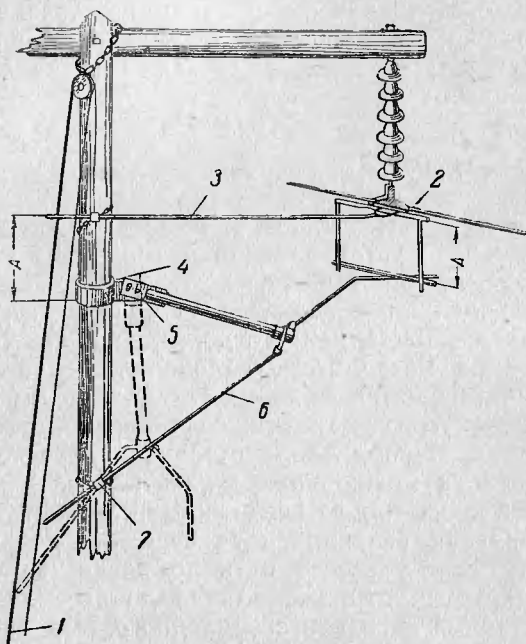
Схема установки трубчатого разрядника под напряжением на деревянной опоре промежуточного типа.
